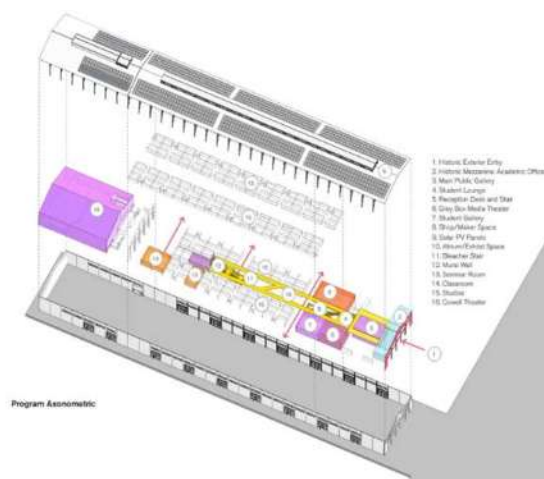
Distribución arquitectónica del Centro Cultural para las artes Mason. Fuente: (ArchDaily, 2018)
